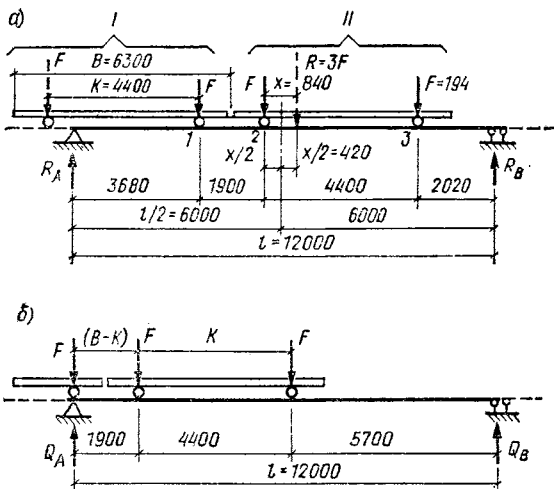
Крановые нагрузки (к примеру VII.1)
